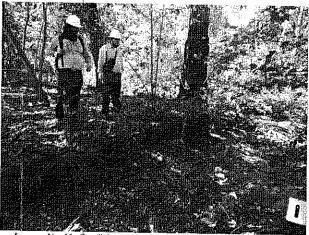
Condiciones en las que se encontró el muro en gavión dentro de la margen izquierda del Drenaje NN\_01. Fuente Propia.
